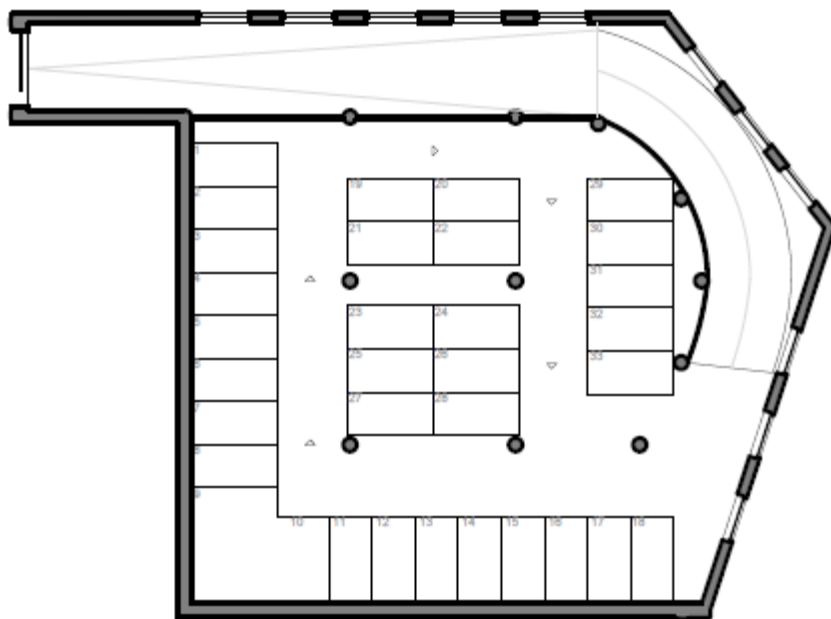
Planta Piso -1, Proposta Escala 1/500 (Autora, 2019)
